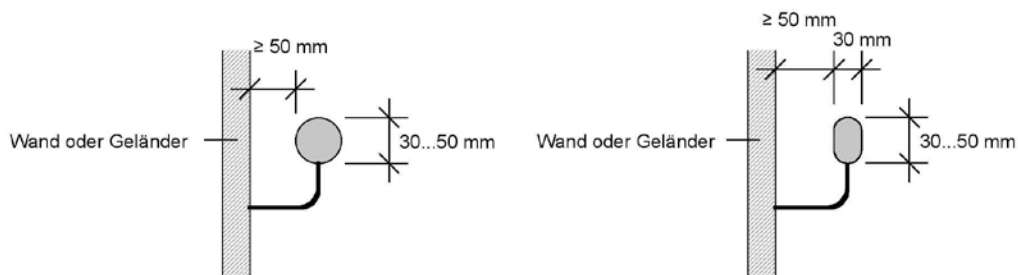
Handlaufprofil und Angabe zu minimalem Wandabstand
